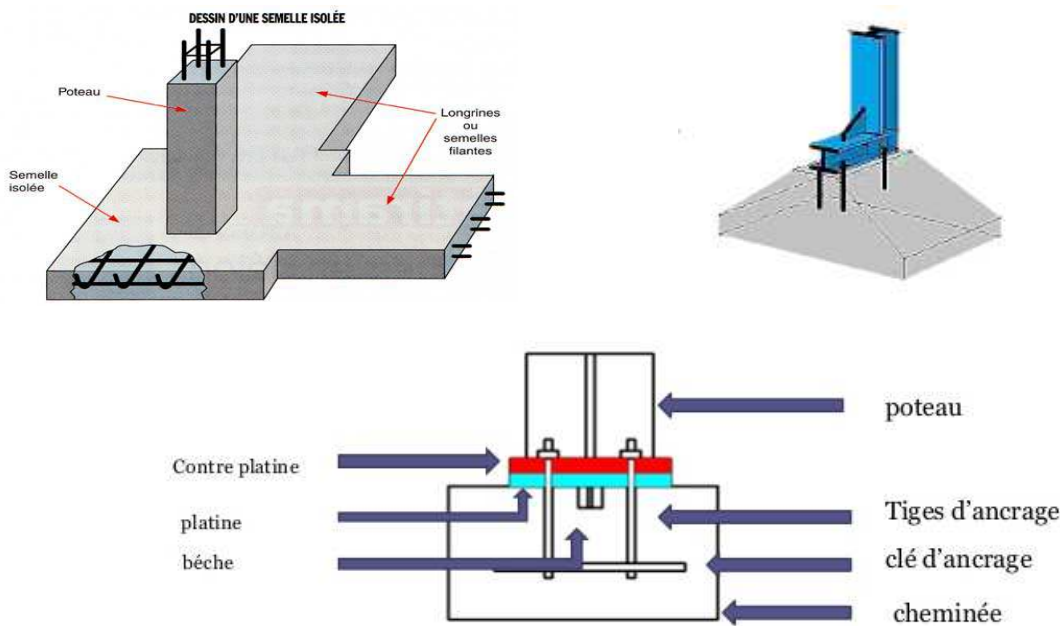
Fixation du poteau métallique aux fondations, source: <http://notech.franceserv.com>
